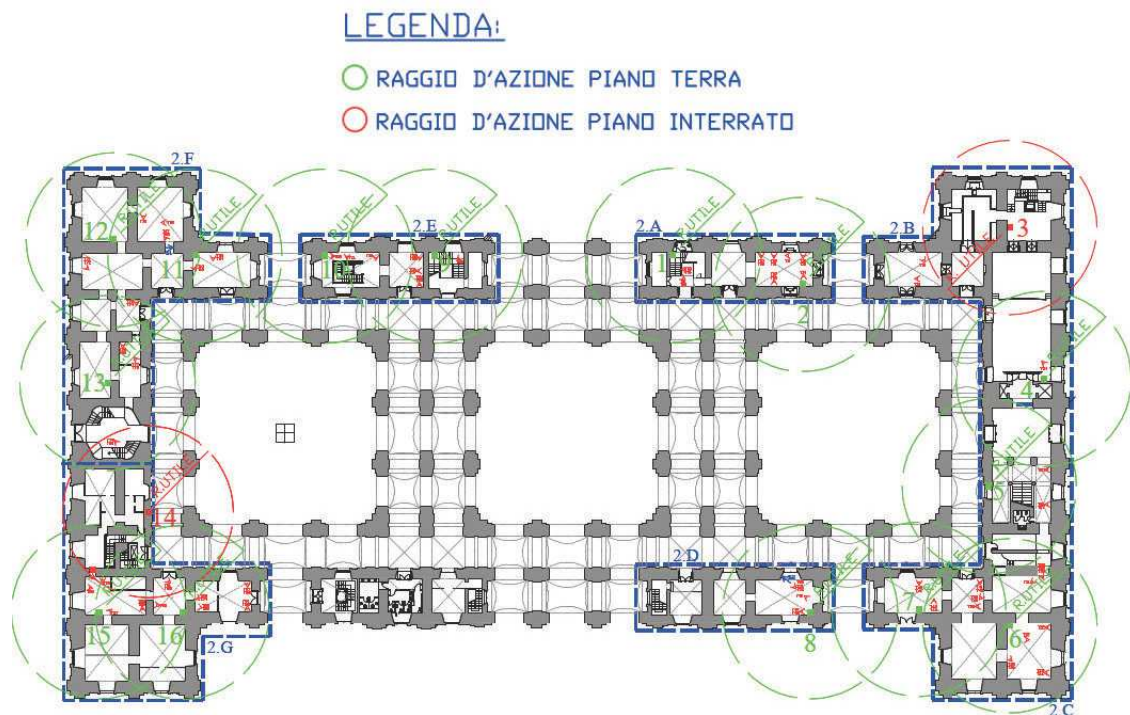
Museo nazionale di Capodimonte: schema planimetrico impianto CNT
